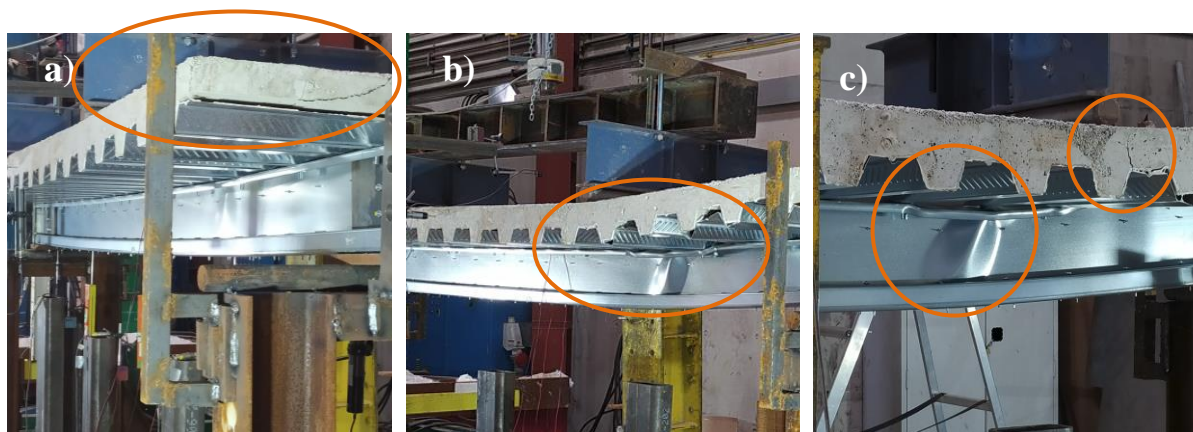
a) Início da rotura em estado plástico. b) Rotura total do provete. c) Pormenor do esmagamento da alma e no banzo superior assim como fissuras no betão.
